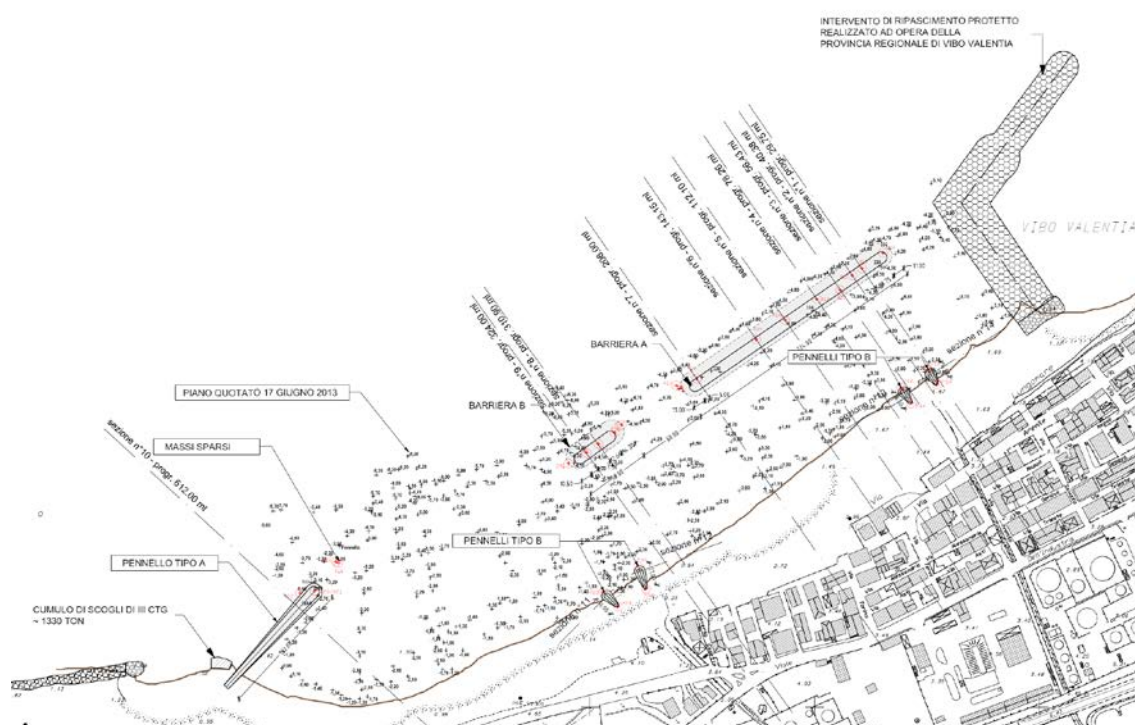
Planimetria delle opere realizzate al primo stato di consistenza – 24.06.2014
